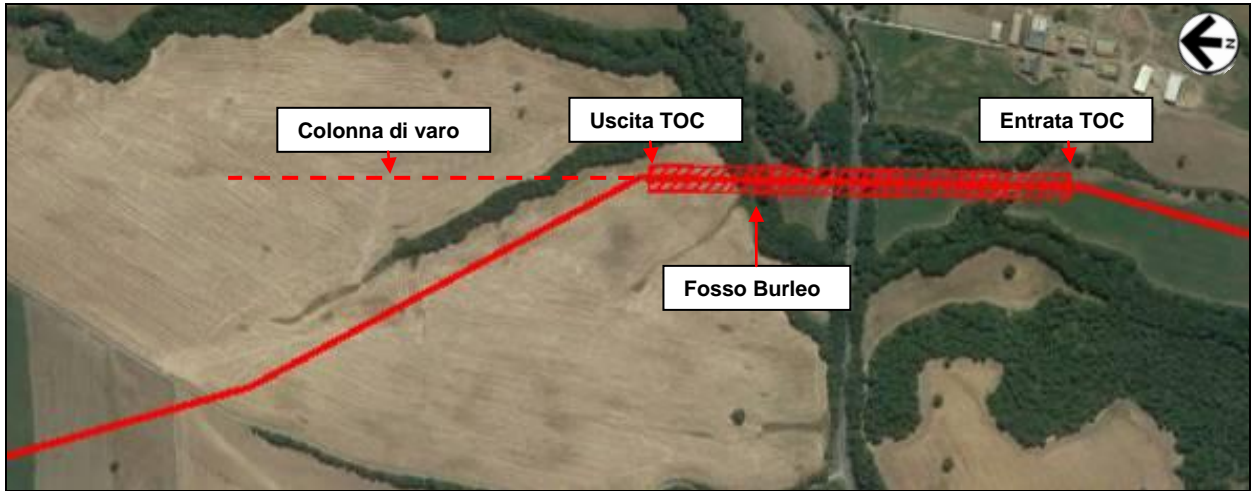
/B – Schema planimetrico della TOC per l’attraversamento del F.so Burleo
